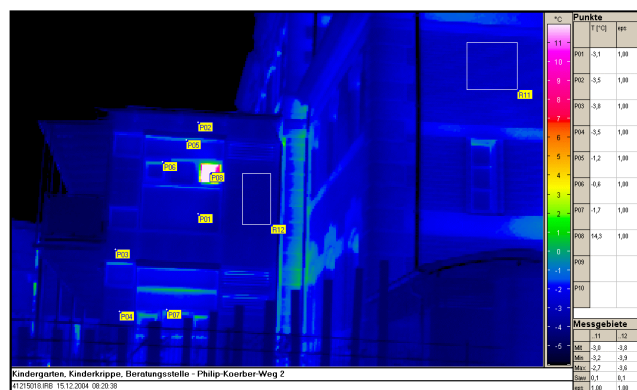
Wärmebild der Ostfassade Alt- und Anbau nach Sanierung
